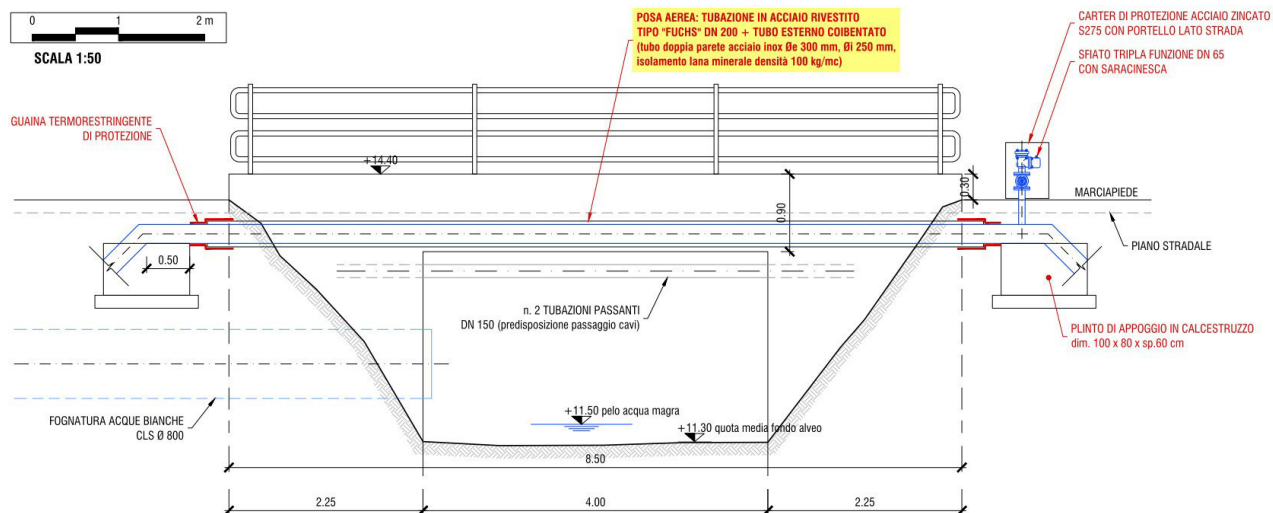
Prospetto attraversamento A, Rio Piovensan sud, interferenza con v.le B.ta Marche
